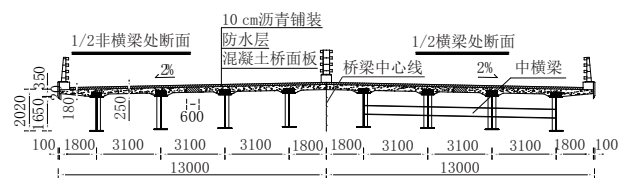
钢板组合梁桥跨中标准横断面图 (单位: mm)
